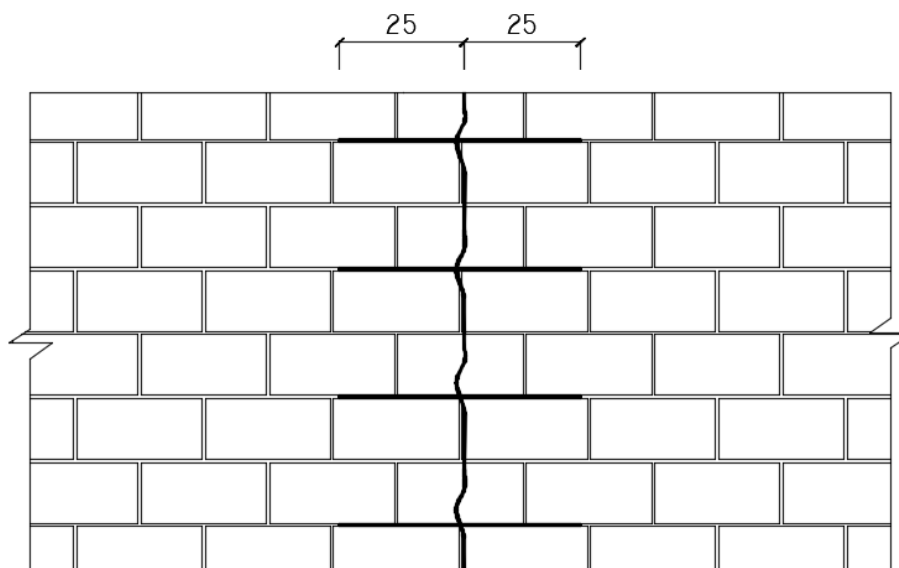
Vista frontal da inserção de barras de aço em elemento de alvenaria fissurado. Fonte: adaptado de Thomaz (1989).
